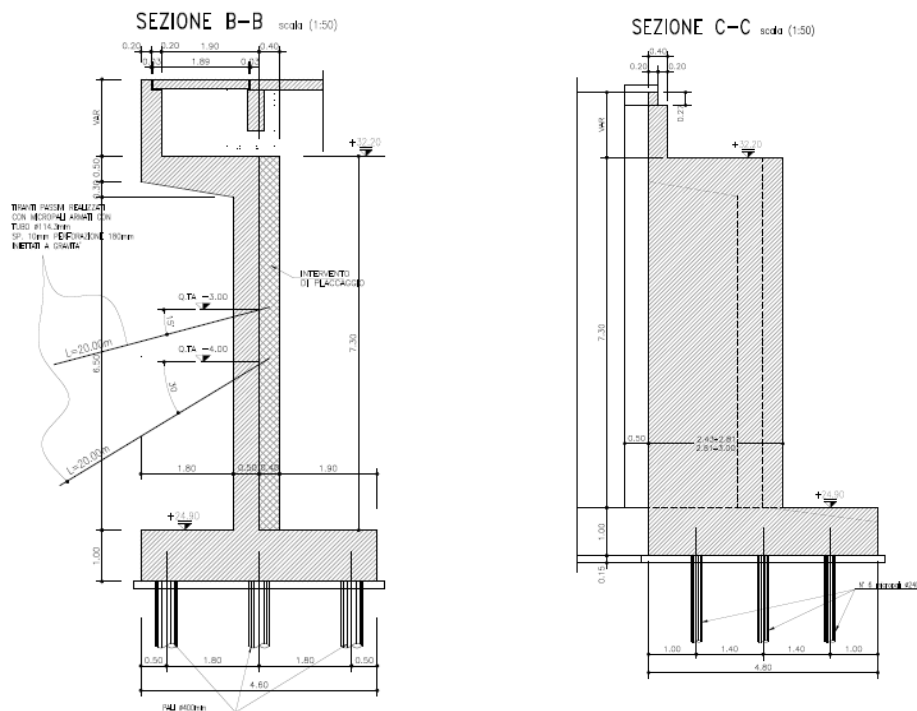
Sezione trasversale spalla lato Ancona: B-B spalla originaria con placcaggio e tiranti; C-C spalla ampliamento 2004
